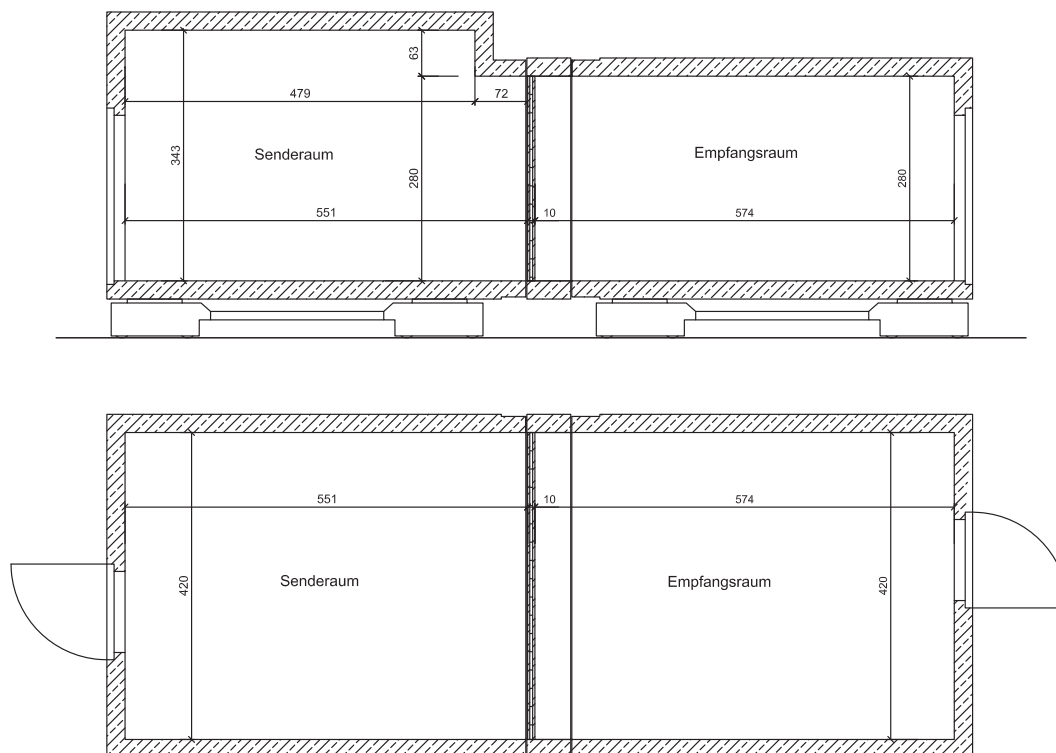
Grundriss (unten) und Schnitt (oben) durch den MFP.
